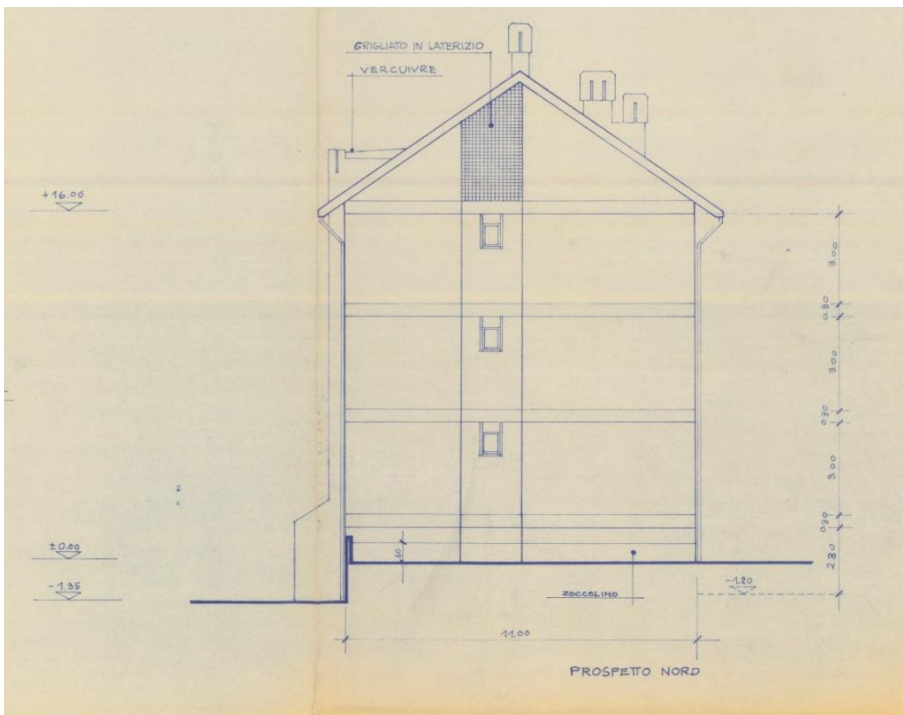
, Prospetto Nord-Ovest, scansione progetto originale
